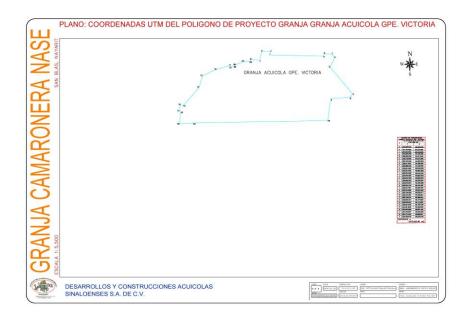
plano de conjunto coordenado de las obras que se pretender volver a operar.
